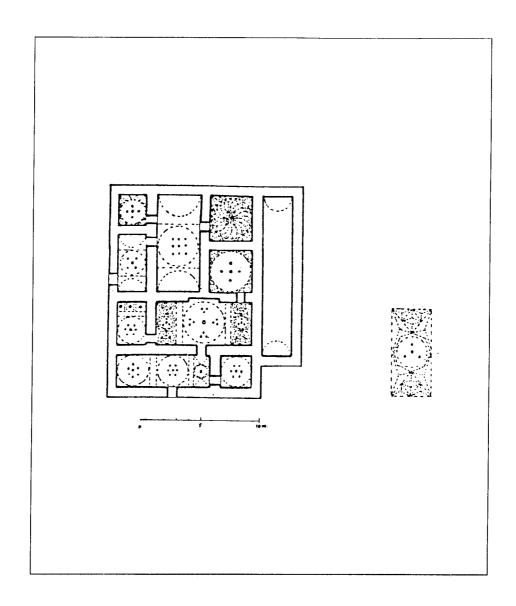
مسقط أفقي لحمام سنان بك في Karnabat (عن : كيل).
